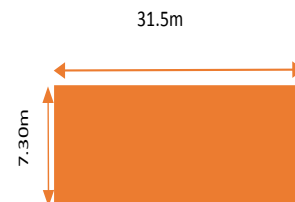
Falla grieta de borde en el pavimento flexible de la avenida Metropolitana
